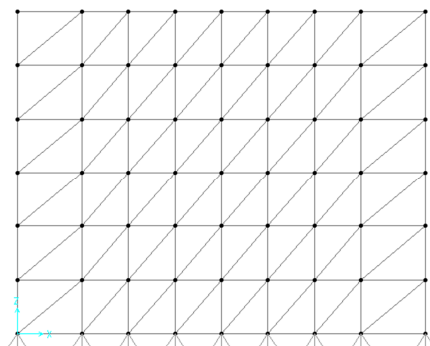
Configuração dos Planos de Contraventamento Vertical Com Elementos de Contraventamento Pequenos
